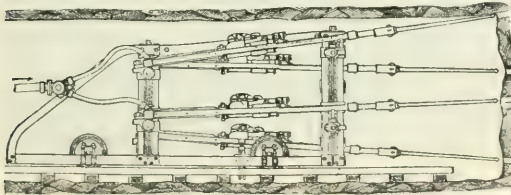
Bohrwagen mit 4 Ferrouxmaschinen.
